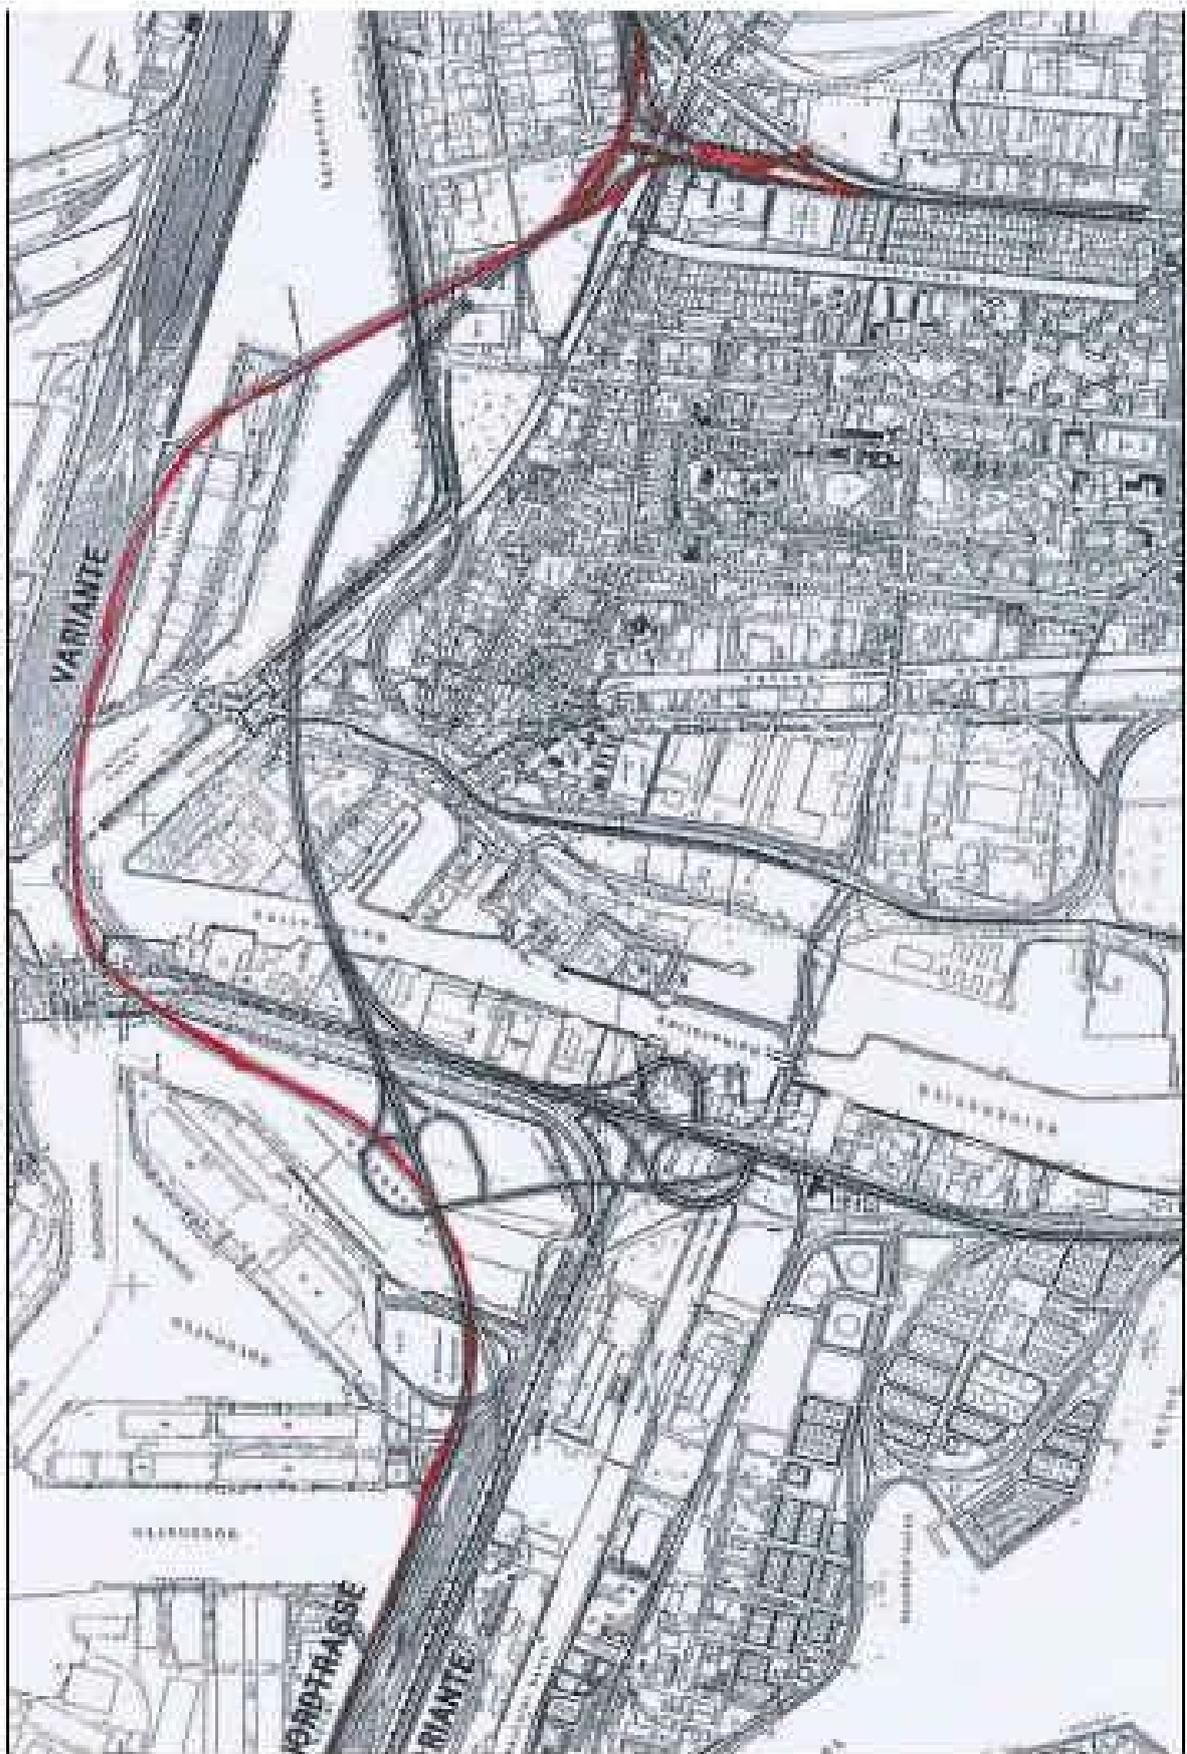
Ausschnitt aus Lageplan „Haupttrassen mit Varianten“, Zeichnung Nr. 28/00-01-059, rot gekennzeichnet: die zur Zeit favorisierte Nord-Nord-Trasse
